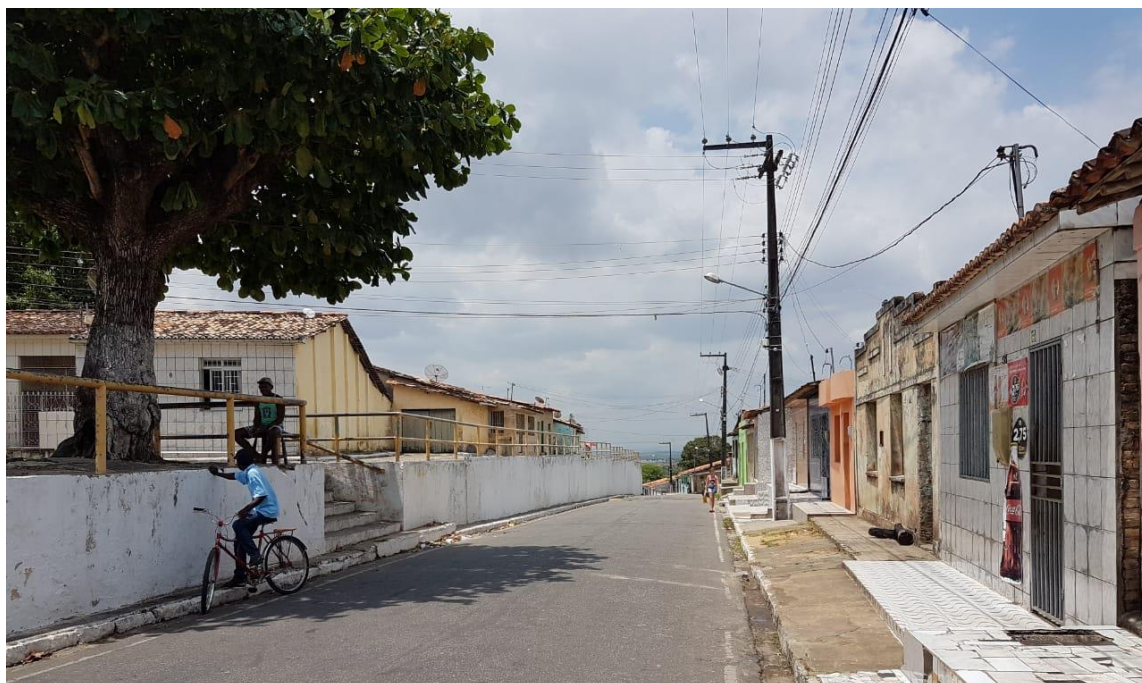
Vista do muro de arrimo existente na Praça São Benedito
